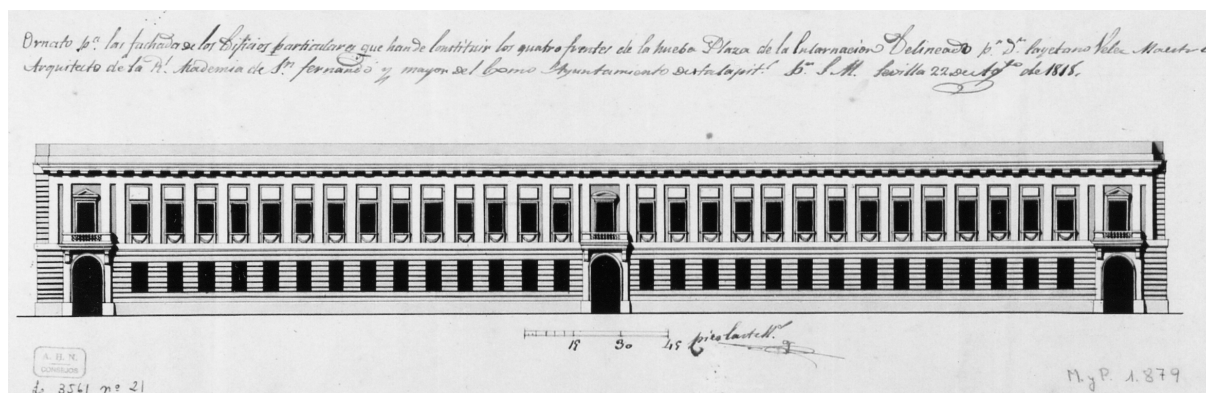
Cayetano Vélaz. Alzado de las fachadas previstas para la Encarnación. 1818. Madrid. AHN.
